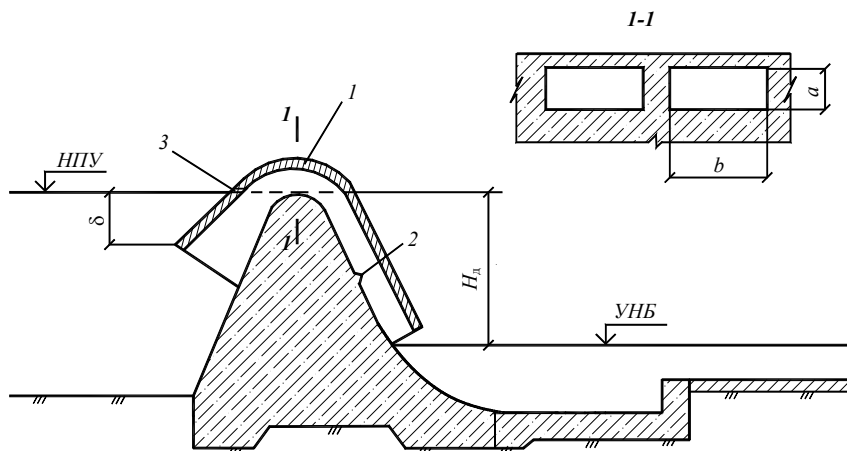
Схема бетонной плотины с сифонным водосбросом:
